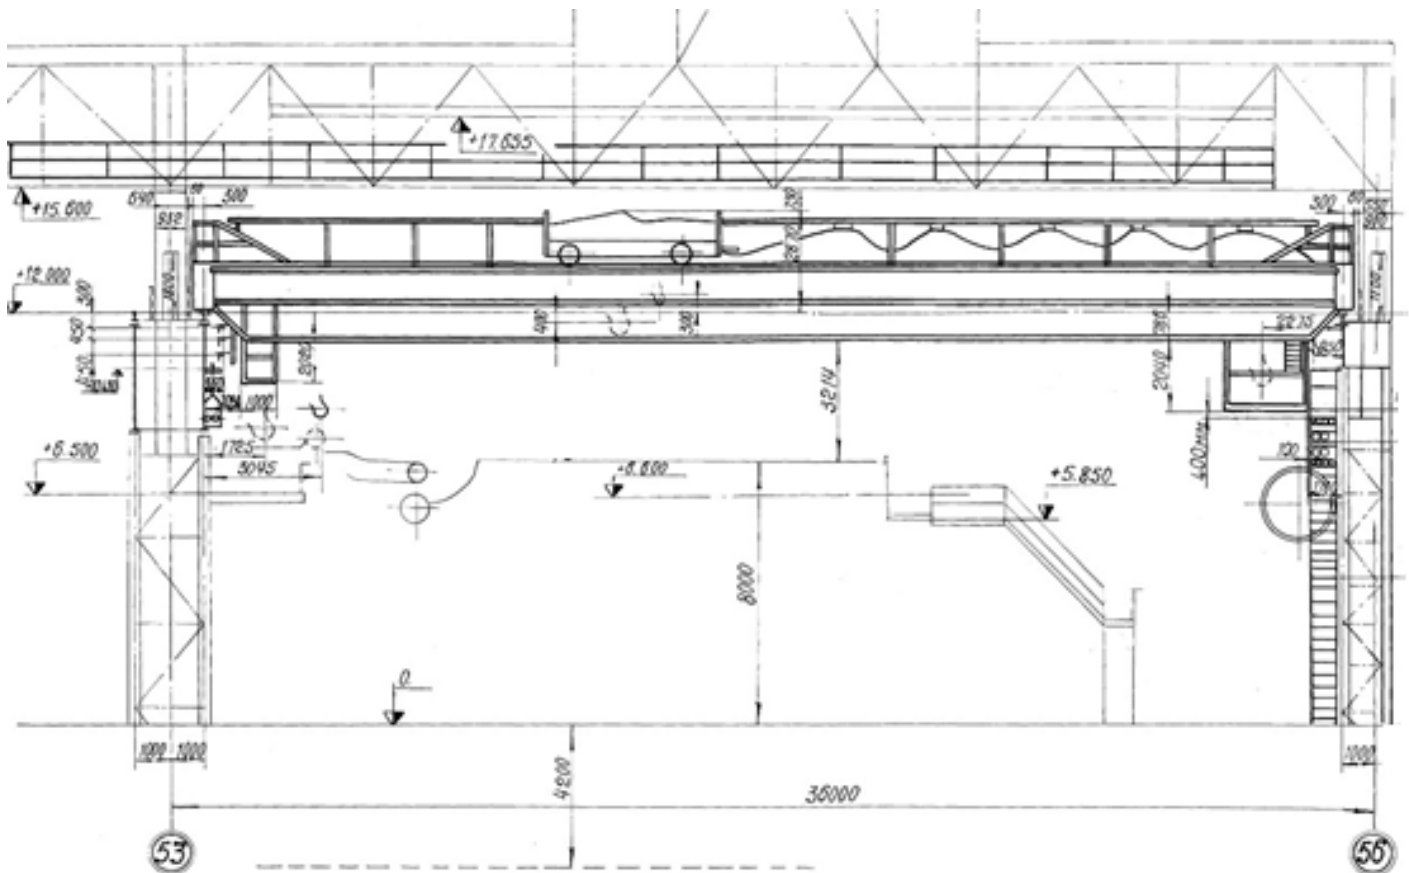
Размеры пролёта для установки устройства гидросбива
